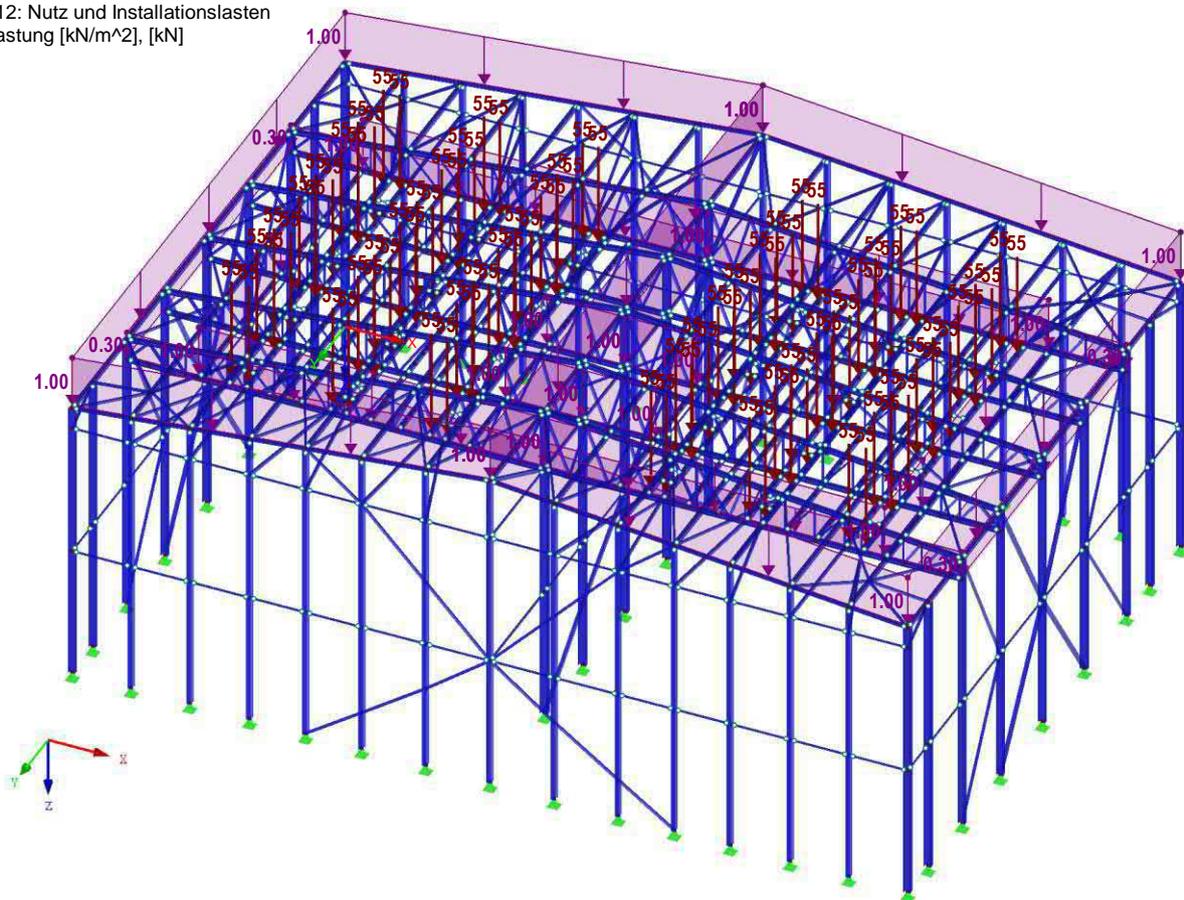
Lastfall 12: Nutz- und Installationslasten
